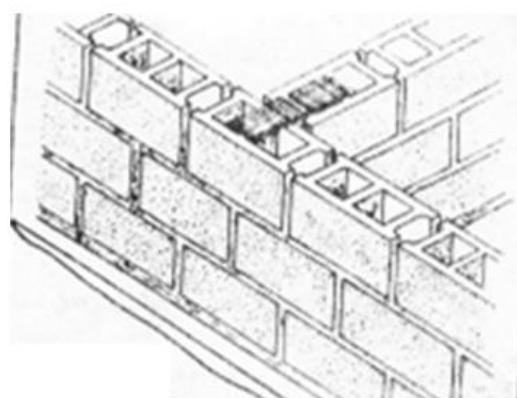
Pemasangan baja beton di sudut pasangan batako
